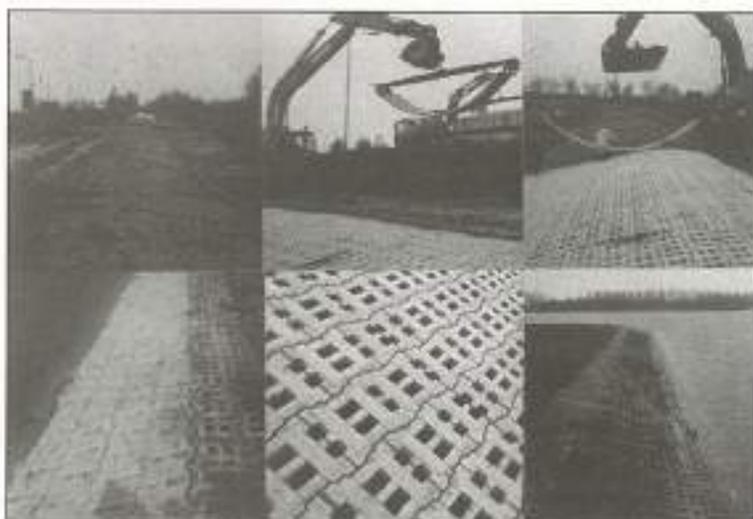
Protecci n de m rgenes con recubrimiento flexible de piezas de hormig n.
